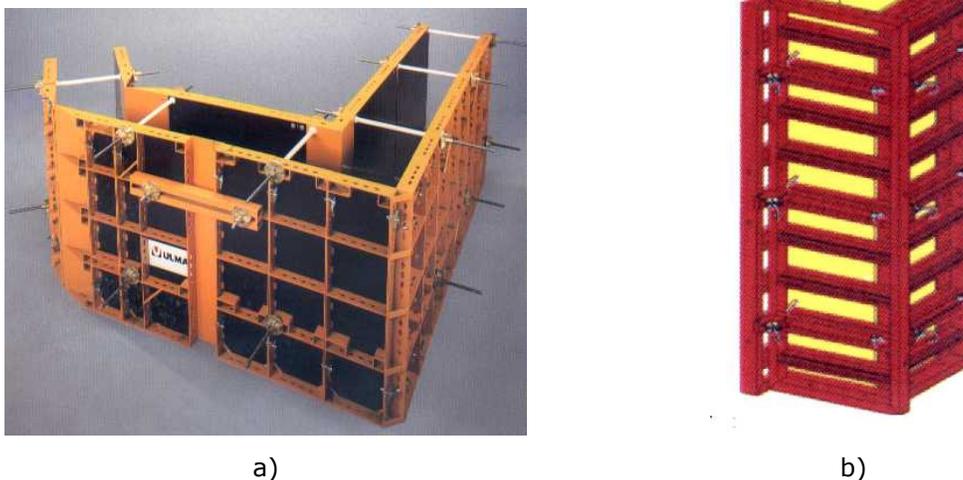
a) Modelo de fôrma modular para parede (Ulma, s.d.); b) modelo de fôrma modular para pilar (Mills, s.d.).
